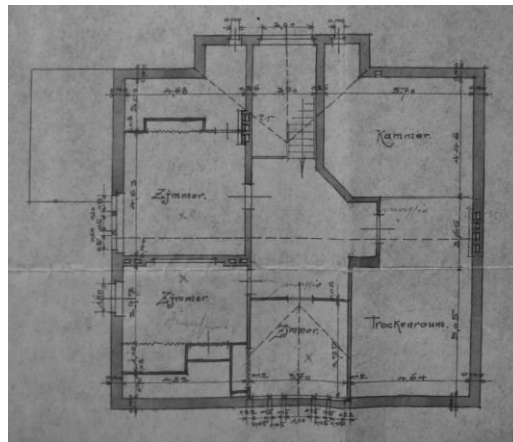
Grundriss Dachgeschoss
